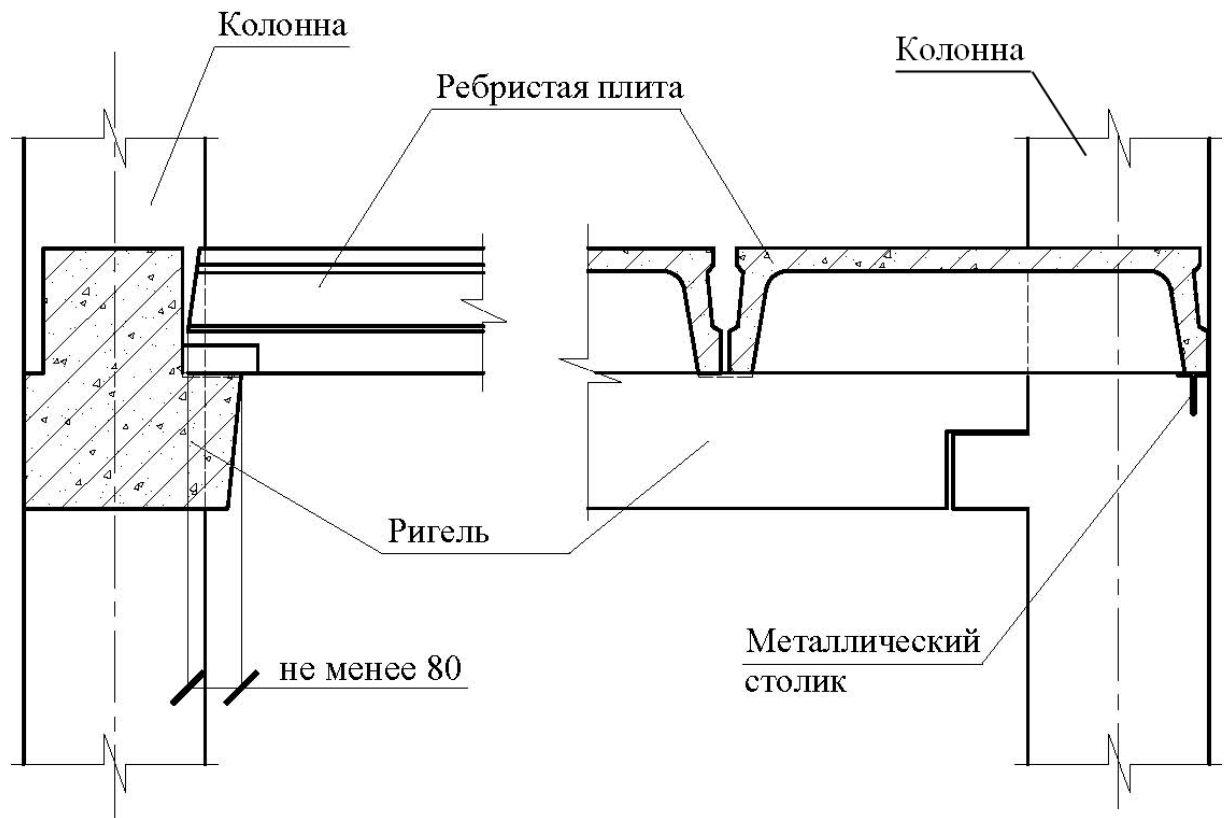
Схема опирания ребристых плит на ригель по крайней продольной оси
